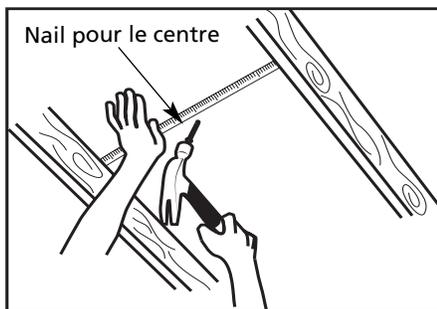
Mettez un clou de passer par le panneau de toiture comme un point central
